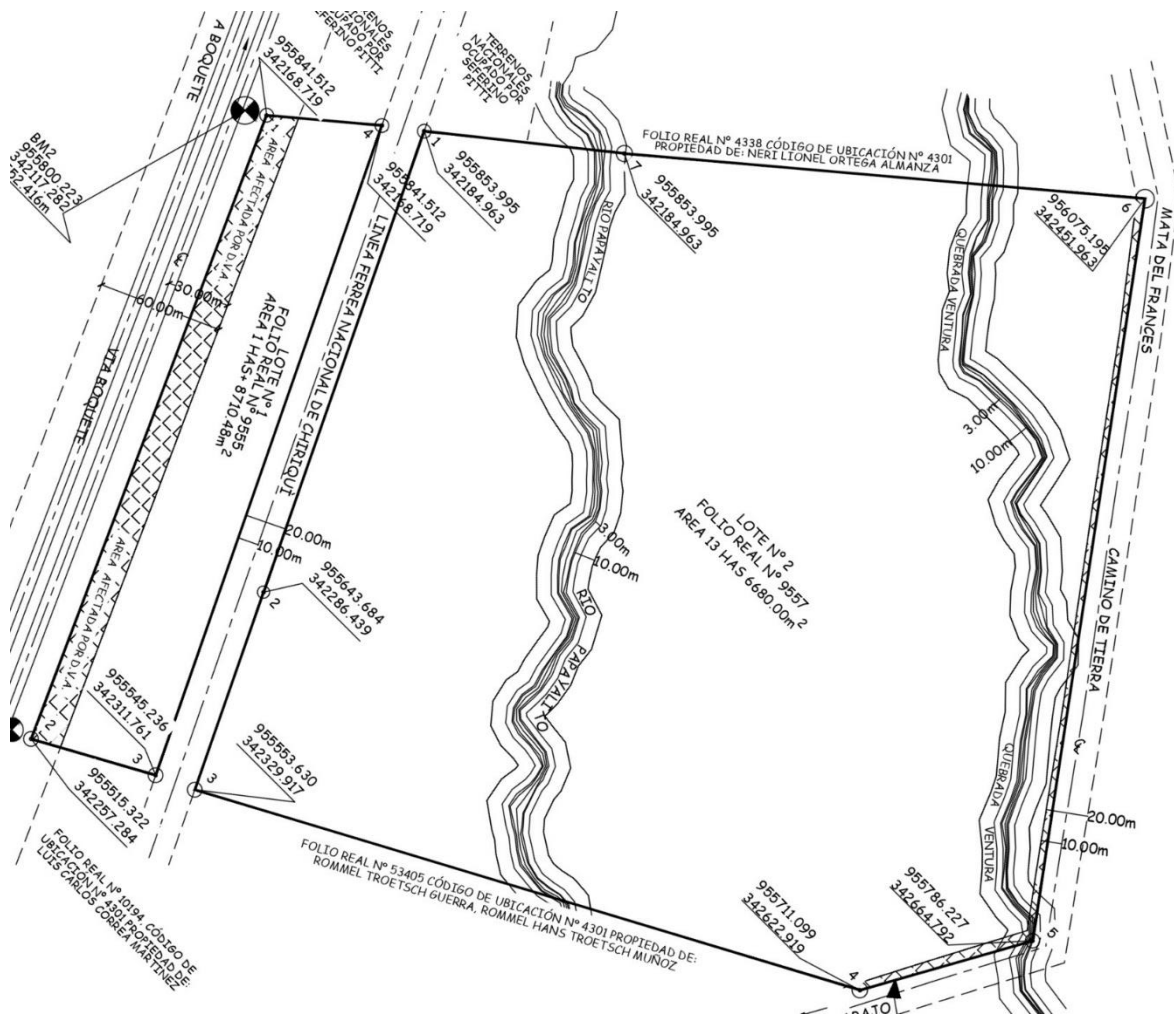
Plano del proyecto RESIDENCIAL JOHNNY WOODLAND. Fuente: PGR Developers Alto Boquete S.A.
